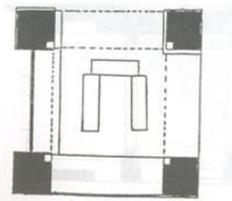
مسقط أفقي لبقعة الشيخ سنان بدر بقرمز بالقاهرة (عن حمزة عبد العزيز) -
